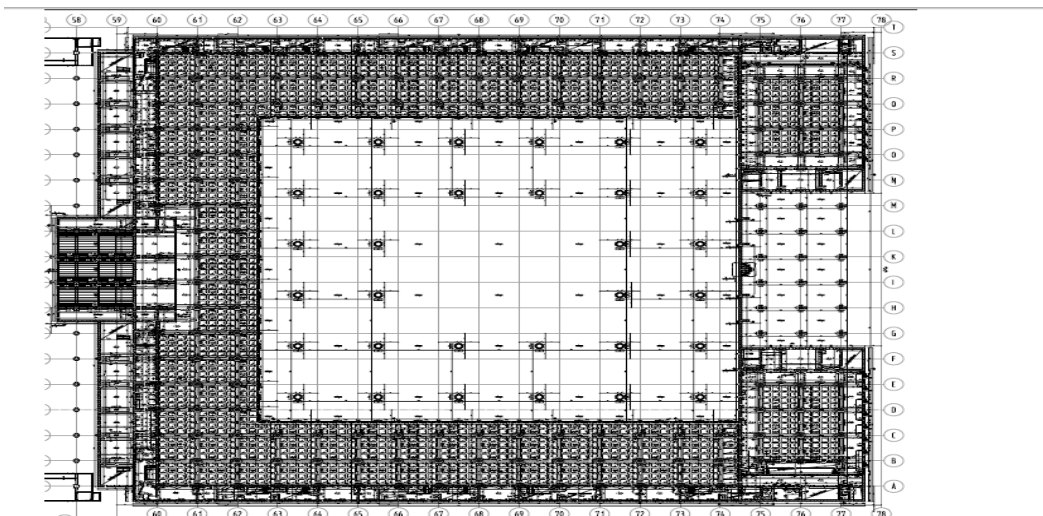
Dalles au-dessus du niveau 010 – vue en plan
